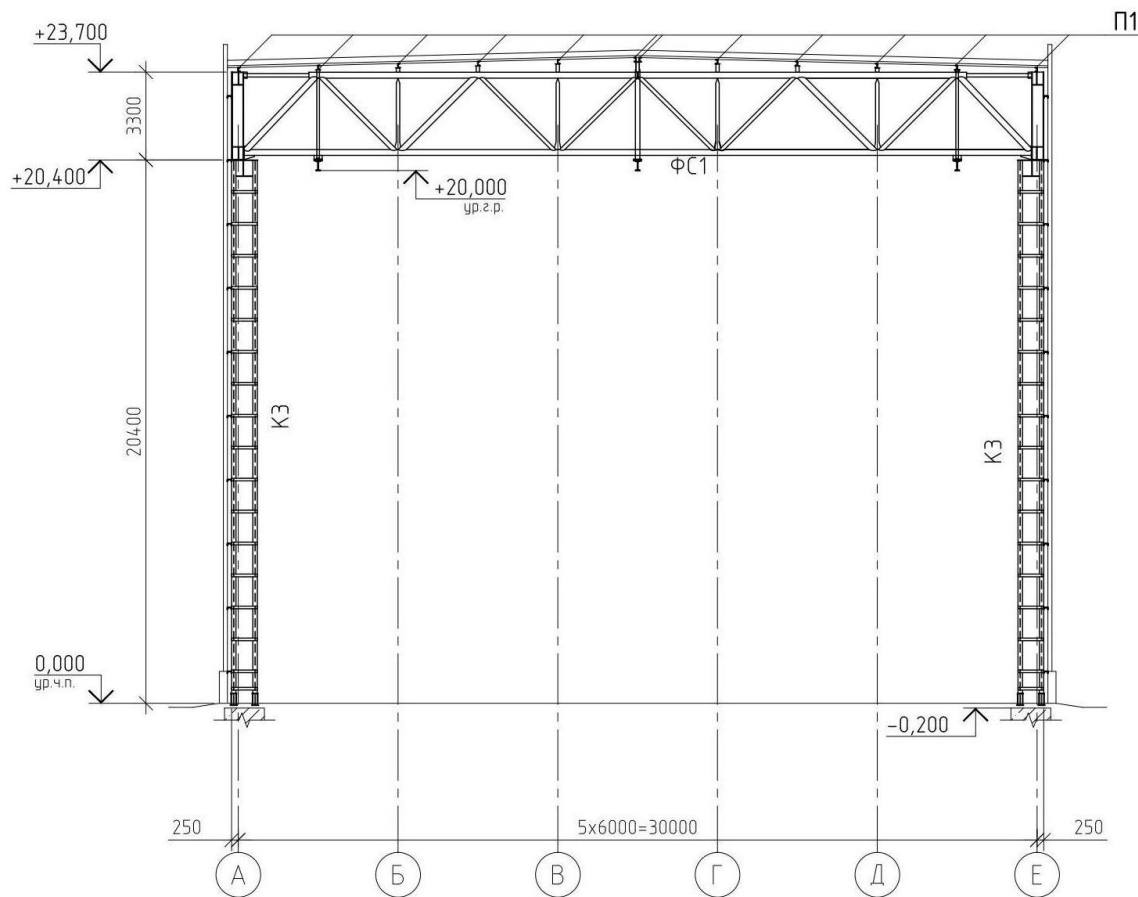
Компонувальна схема поперечної рами в осях 1-6 3-3
